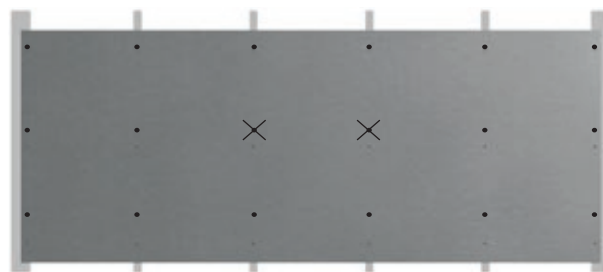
Eksempel: vandret monterede plader med fire mellemliggende stålprofiler
